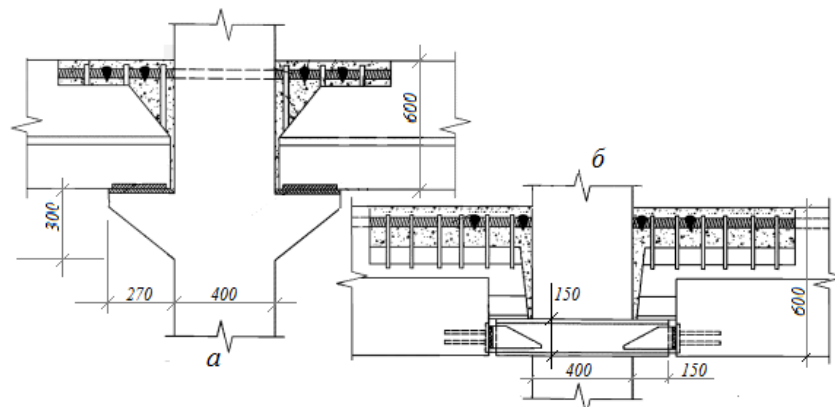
Варианты конструктивного решения жесткого сопряжения ригеля и колонны: а – ригель без подрезки с опиранием сверху на консоль; б – ригель с подрезкой с опиранием сверху и креплением к боковой поверхности короткой консоли
